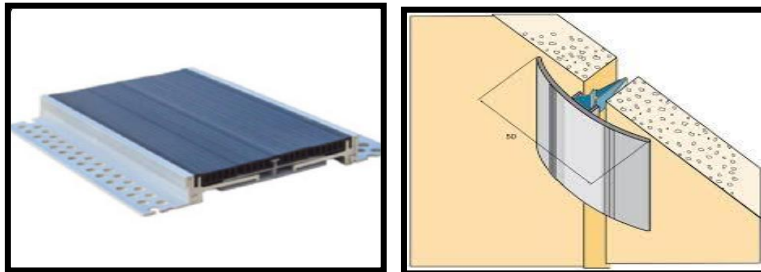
Couvre joint à visser Figure 187 : couvre joint a clipser
